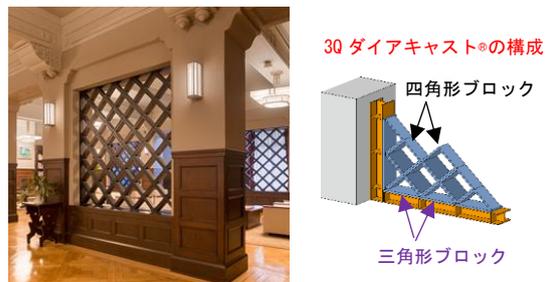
3Q ダイアキャスト®を用いた 3Q-Wall
